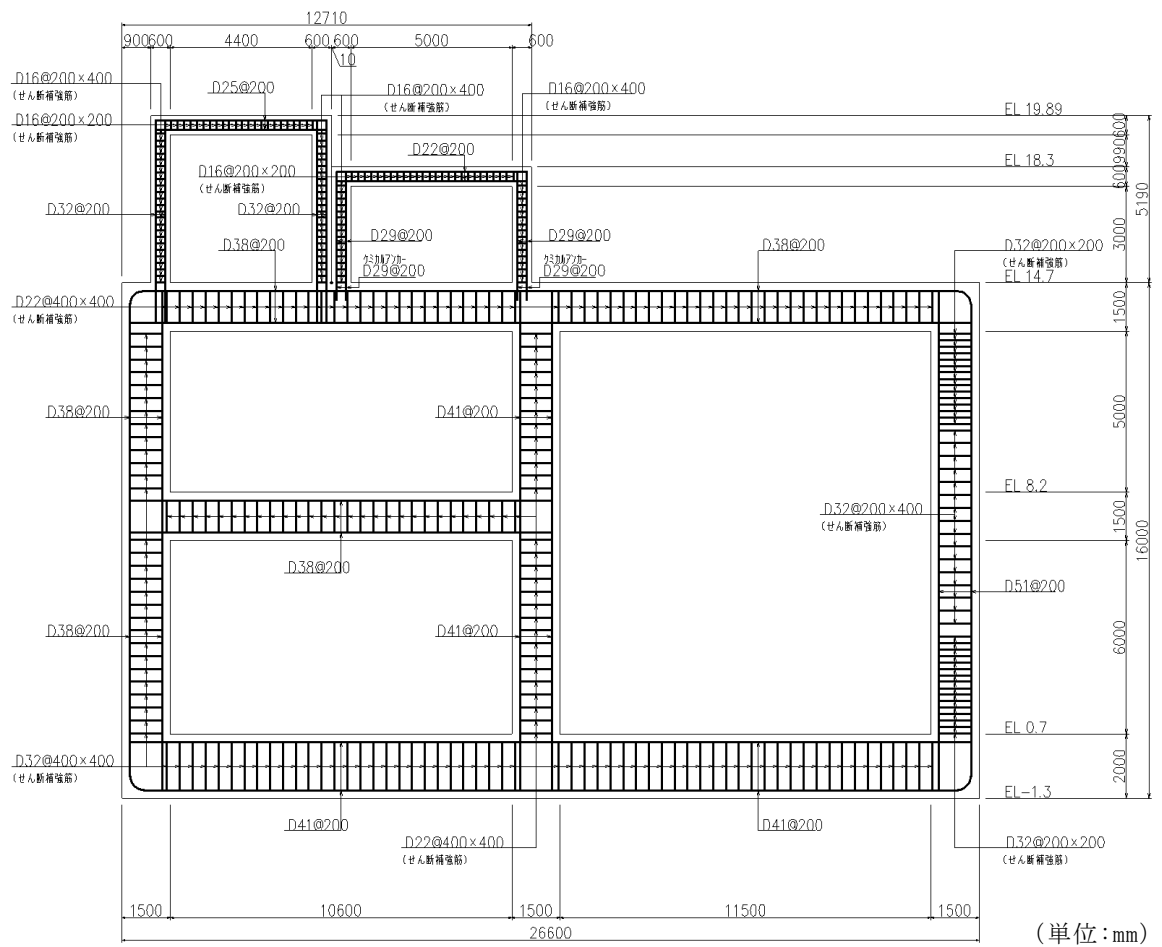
低圧原子炉代替注水ポンプ格納槽 概略配筋図 (C-C 断面)
